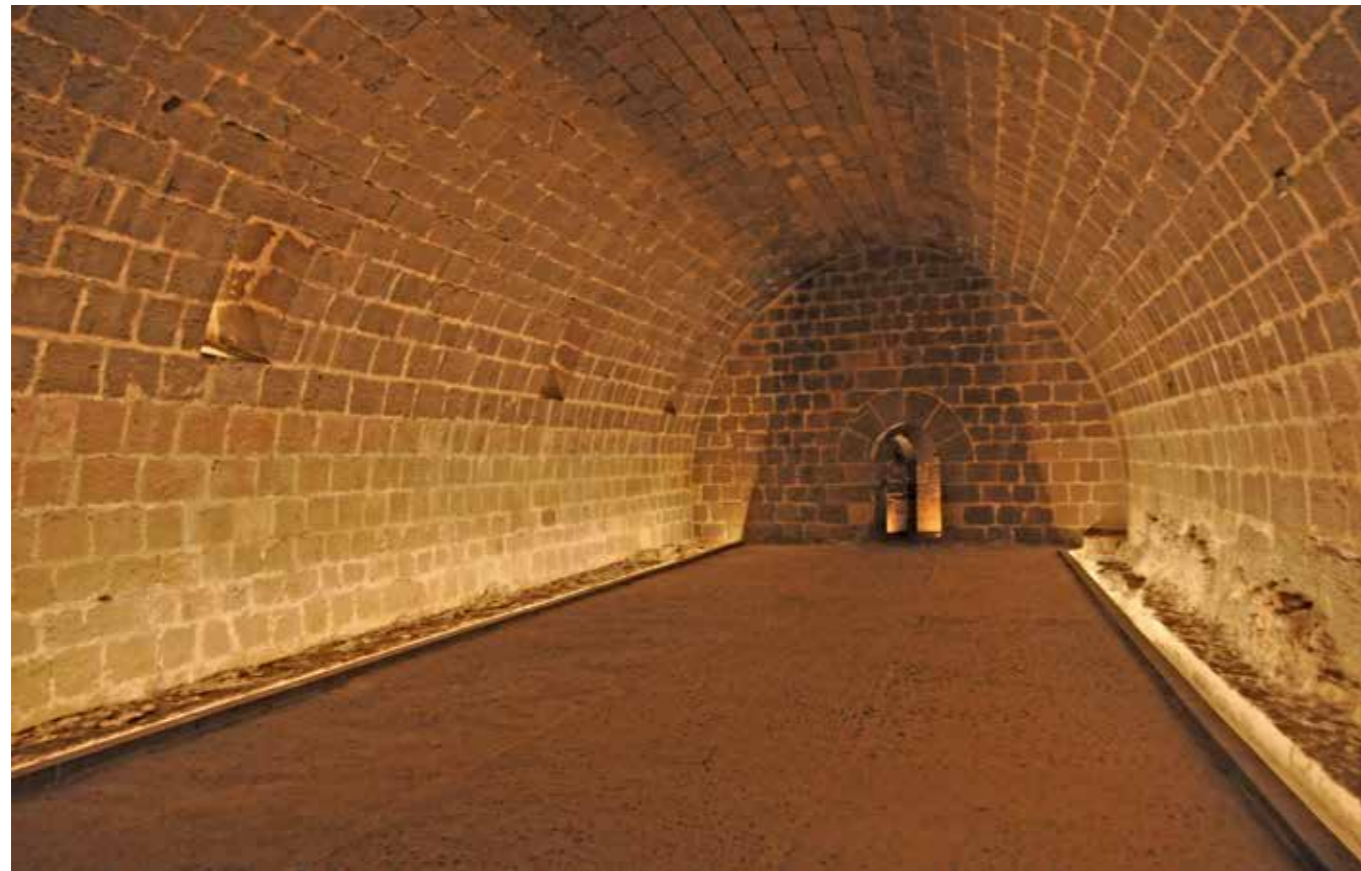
Sala de las caballerizas tras su restauración en la que se ha dejado un foseado que marca el nivel del pavimento original y permite ver las bases de piedra descubiertas en los laterales. Antes esta zona estaba cubierta por el pavimento de enmostrillado. (MJB 2015).
